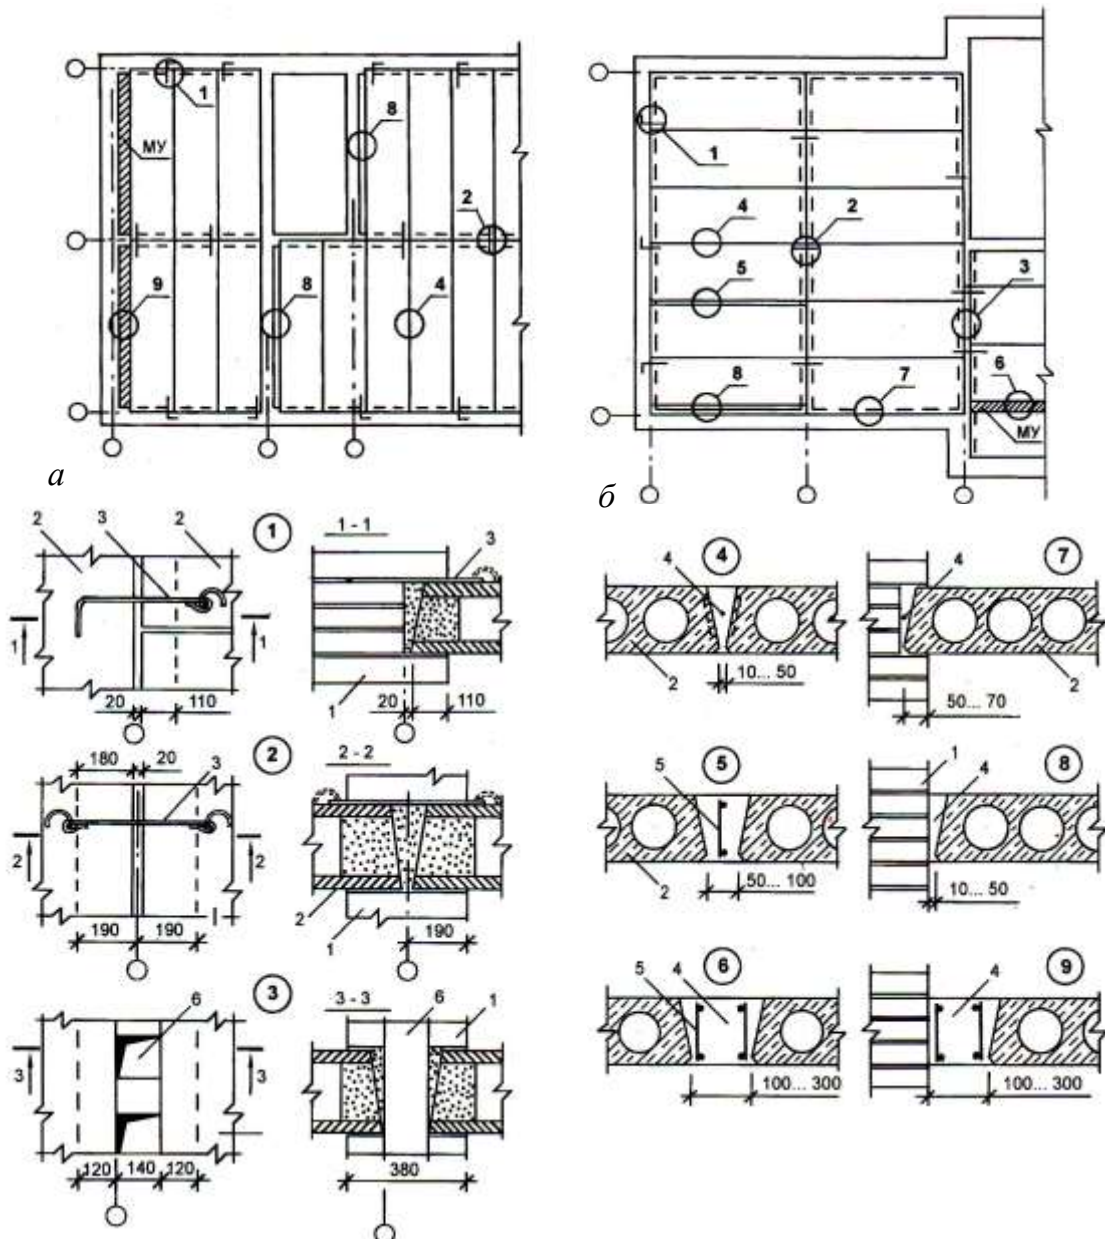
Перекриття з багатопустотних плит в будівлях з цегляними стінами:
